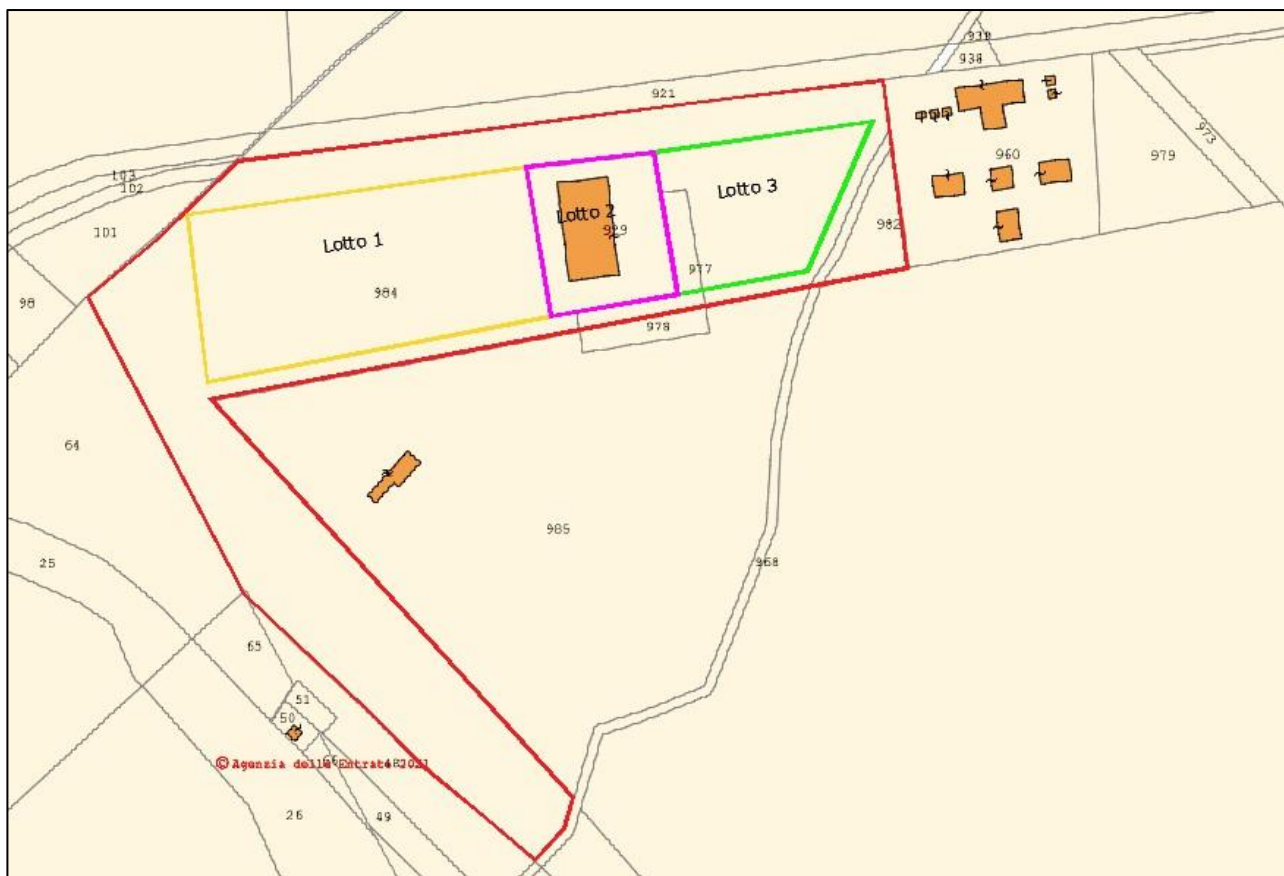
Individuazione lotti sui cui ricade la nuova area impiantistica (Lotto 2 e Lotto 3)
